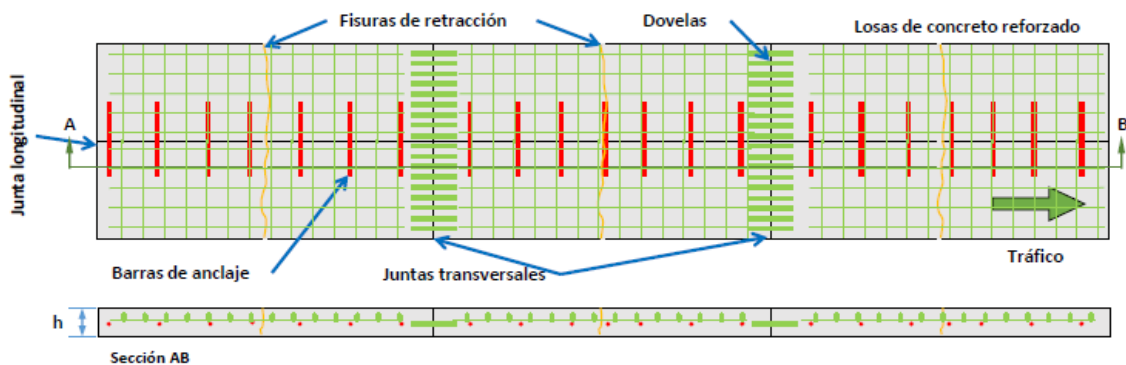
Pavimento de concreto reforzado con conectores, por Vásquez, 2017.
